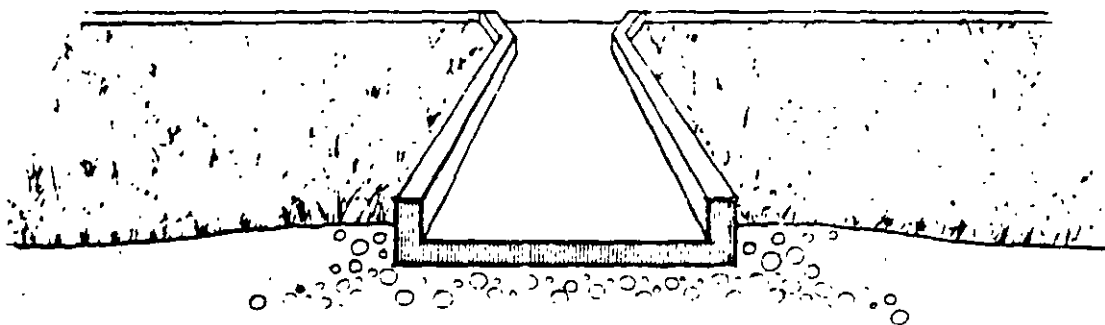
PARAPETO DE CONCRETO COMO PRIMER PLANO. OBTENIENDOSE SOMBRA SOBRE LA ESTRUCTURA
